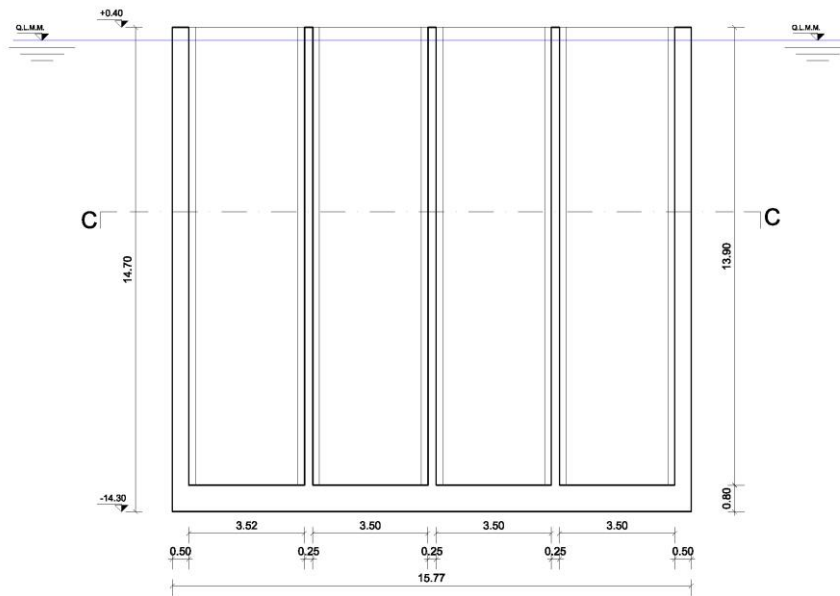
Carpenteria dei cassoni. Sezione A-A
